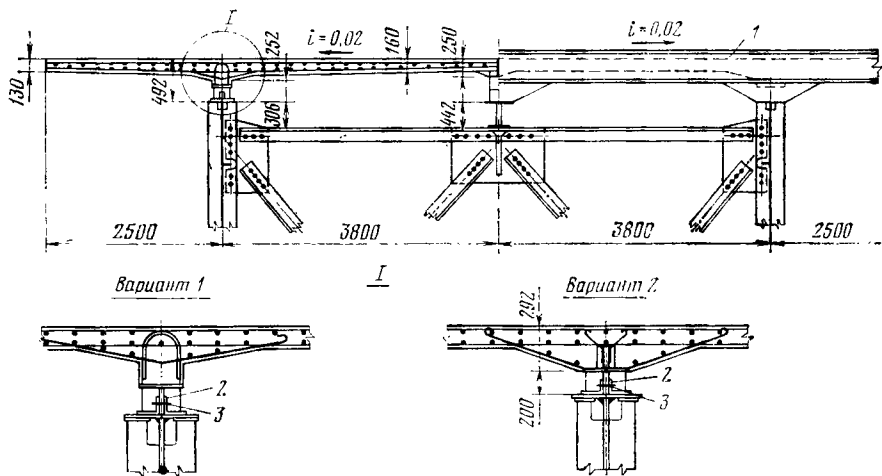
Крепление железобетонной плиты к стальным балкам высокопрочными болтами:
